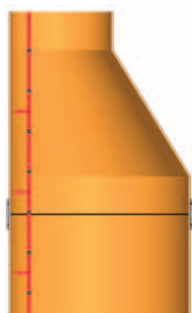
Betonowa płyta nastudzienna zintegrowana z pierścieniem do łączenia standardowych zwężek betonowych
